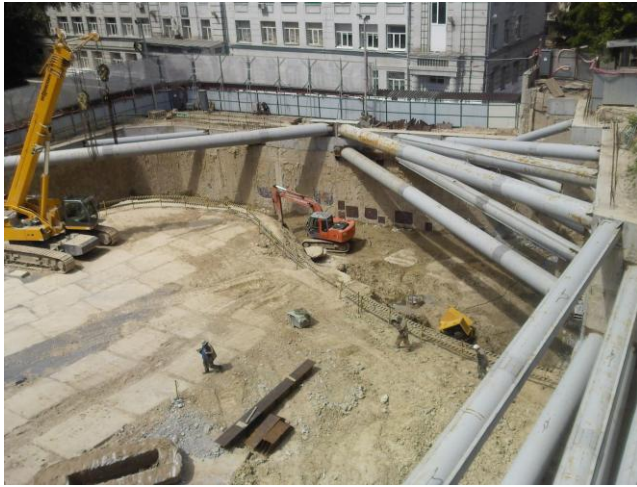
Ограждение котлована «стеной в грунте» с распорными элементами
